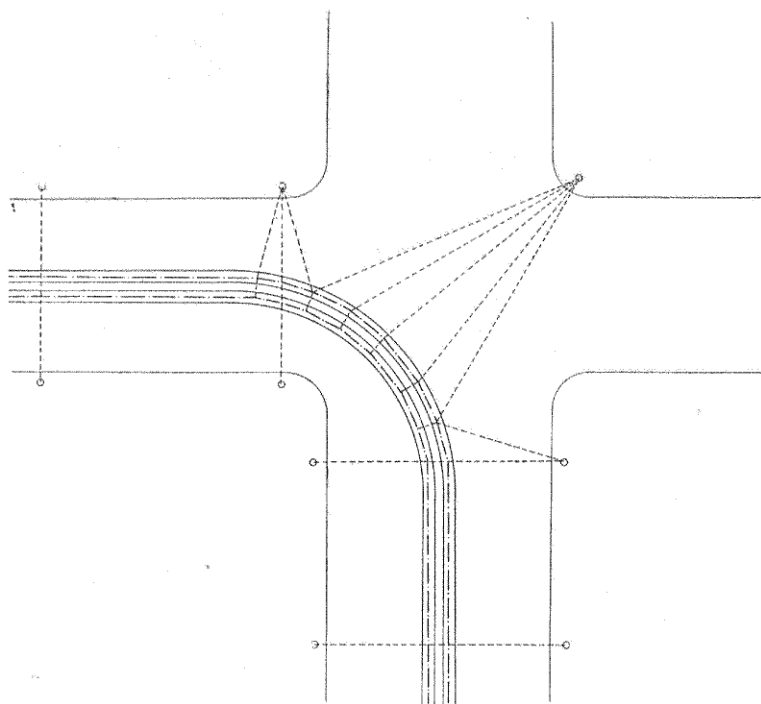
Faisceaux de fils transversaux issus d'un même poteau pour ligne axiale.
